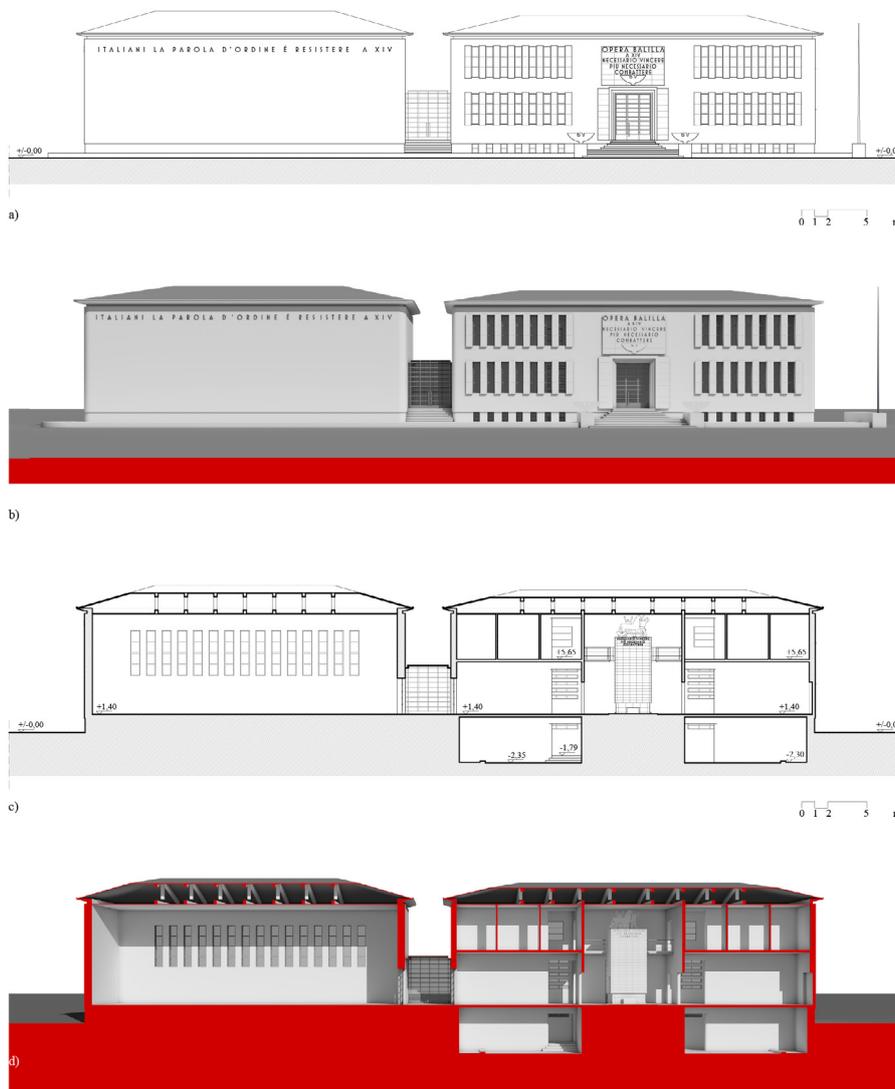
Ridisegno della Casa del Balilla di Luigi Moretti per la città di Bitonto: a) Sezione AA; b) Sezione prospettica AA; c) Sezione BB; d) Sezione prospettica BB.
